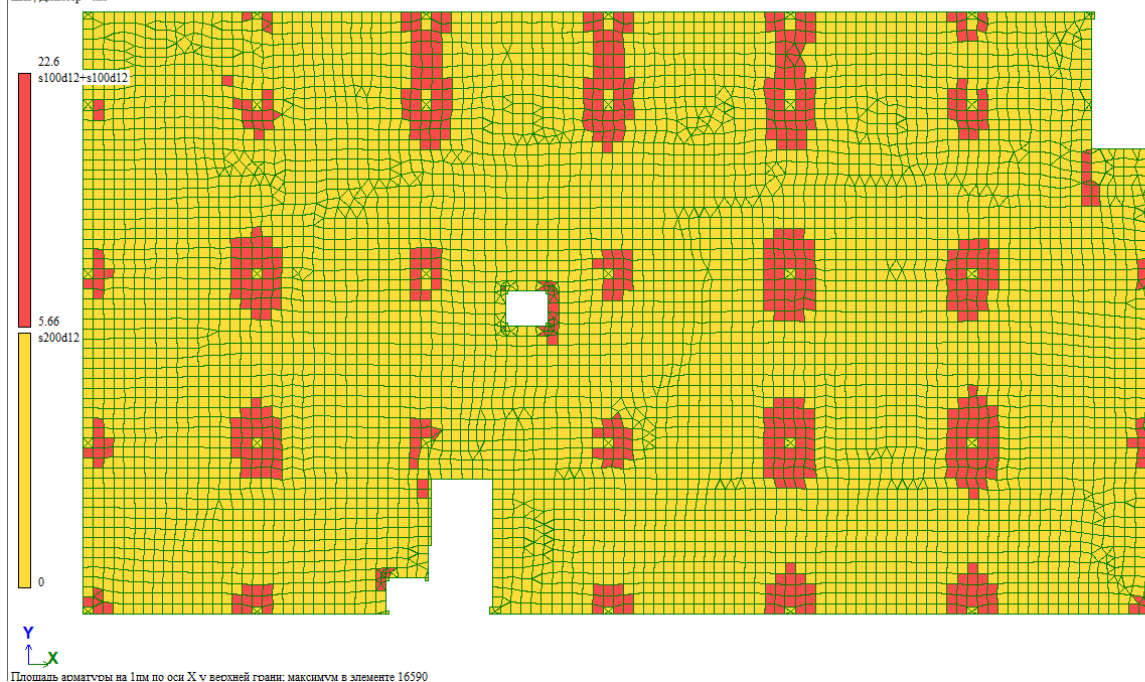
Площадь армирования на 1 м.п. по оси X у верхней грани
